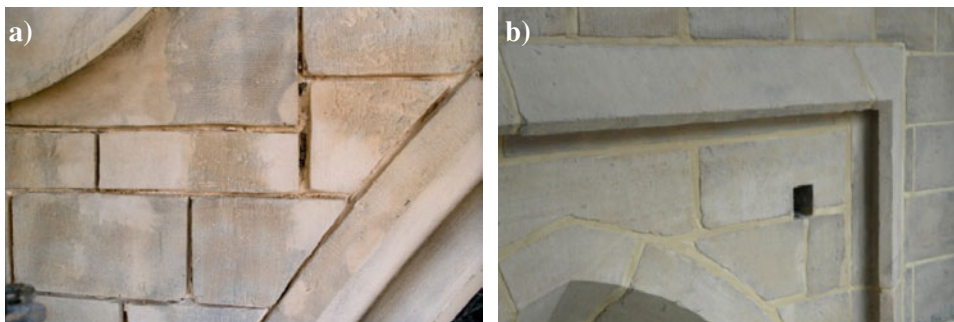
Ubytki elementów kamiennych spowodowane spoinowaniem zaprawą cementową
